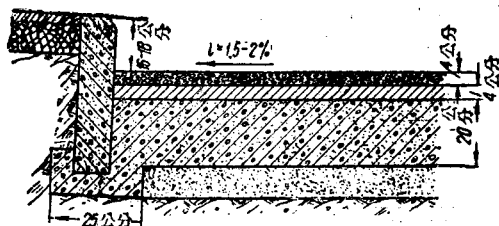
鋪在水泥混凝土基底上面的双層地瀝青混凝土
